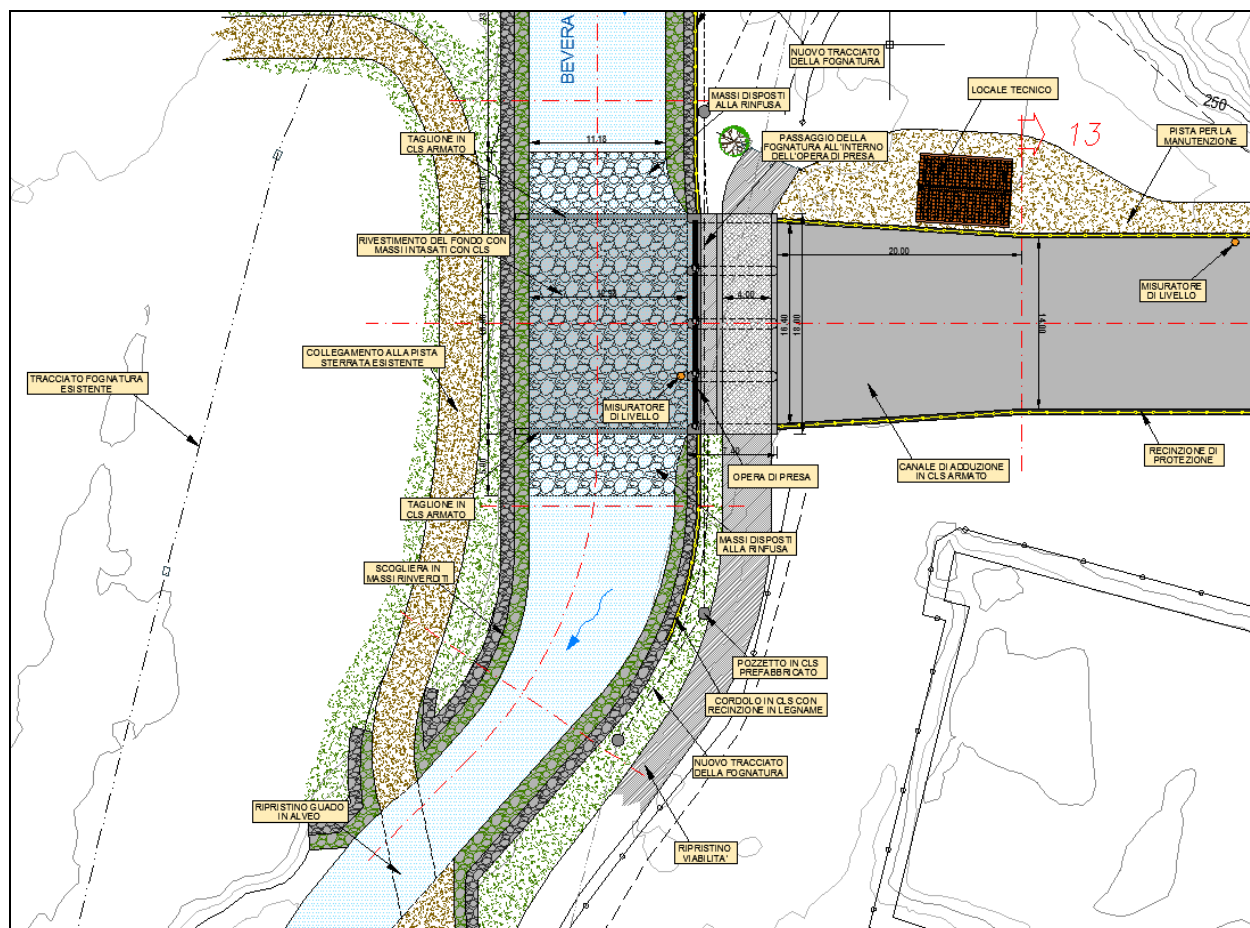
Stralcio planimetrico progettuale dell'opera di presa
